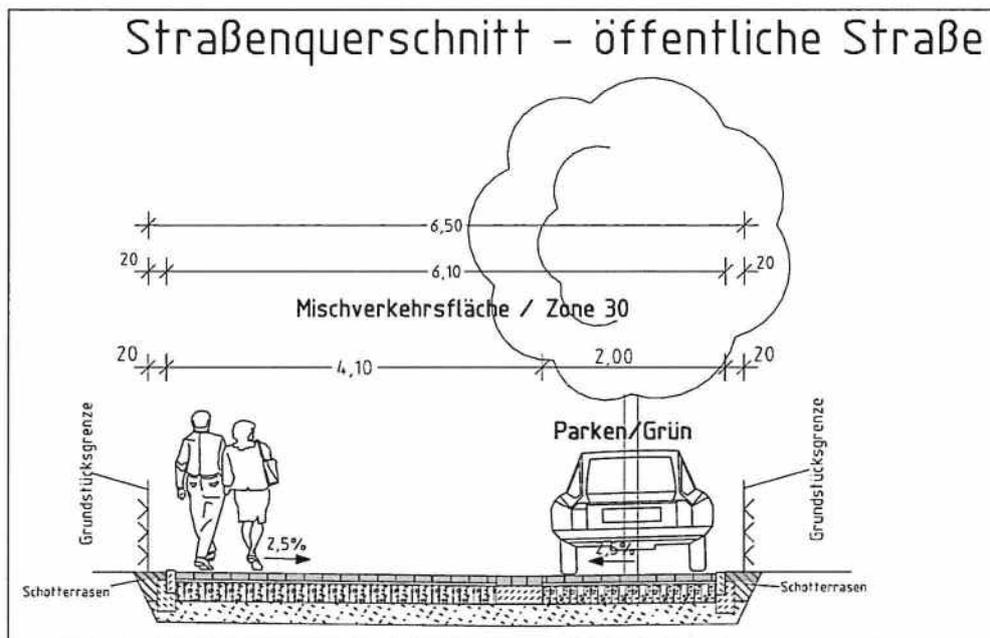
Innere Erschließung des Plangebietes (Quelle: M+S Planungsbüro 2020).
